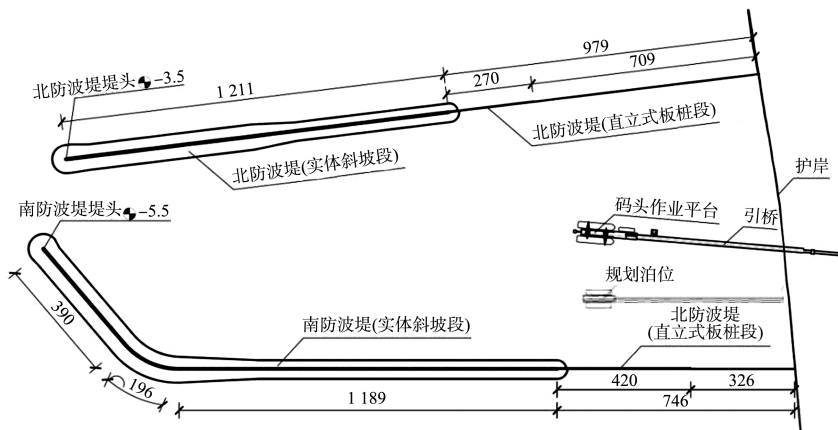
块石防波堤+单板桩防波堤的组合结构平面布置 (单位: m)
